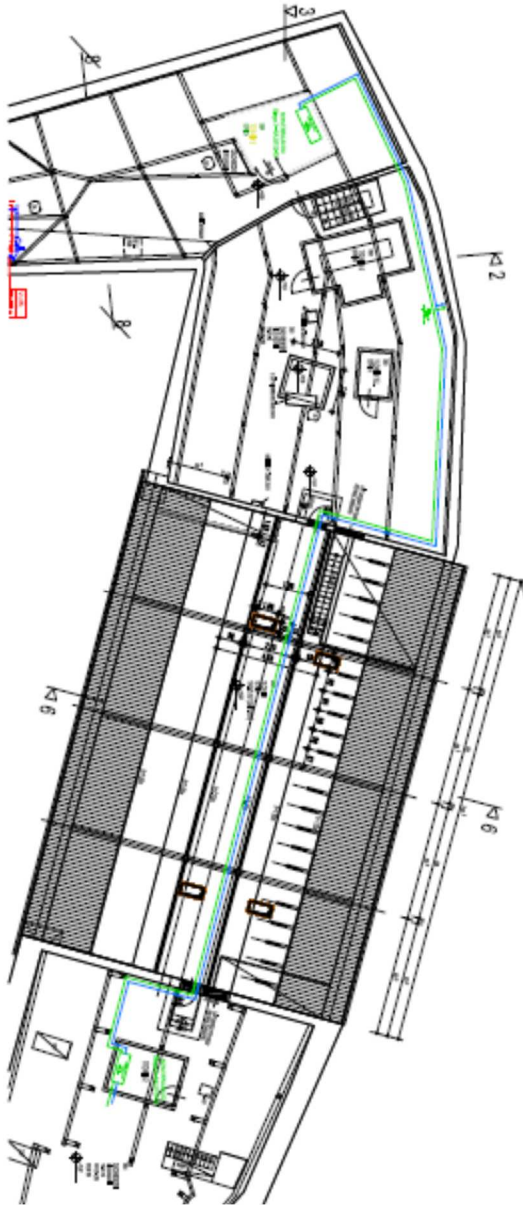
Grundrissausschnitt Dachgeschoss
